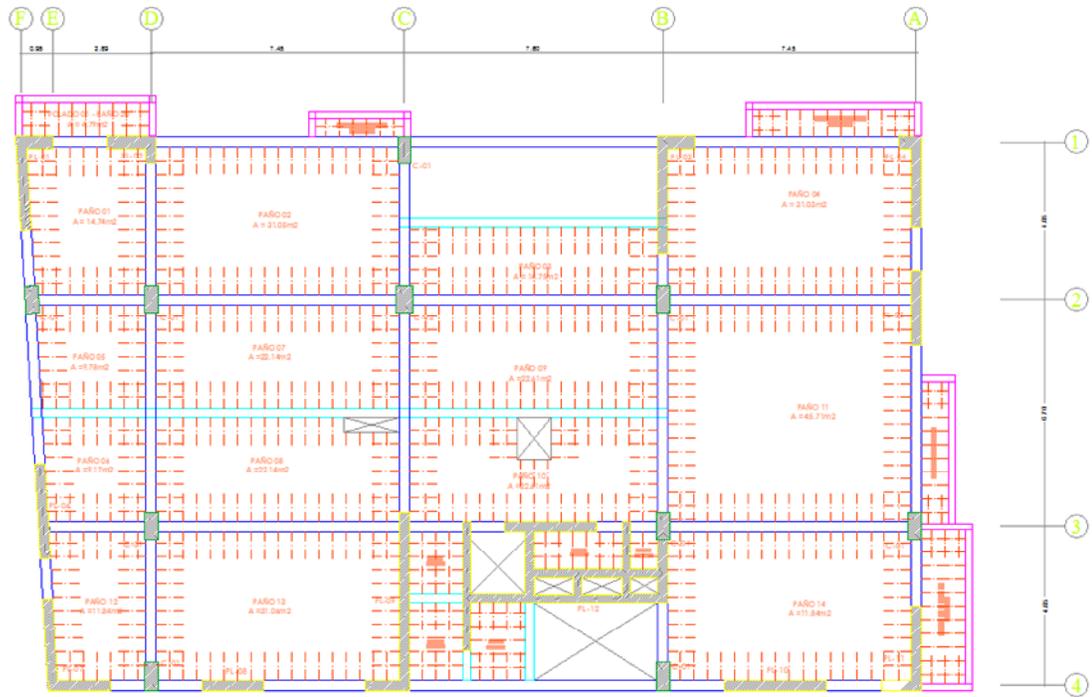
Dirección del Aligerado en Planta – 2do, 4to, 6to, 8vo piso.
